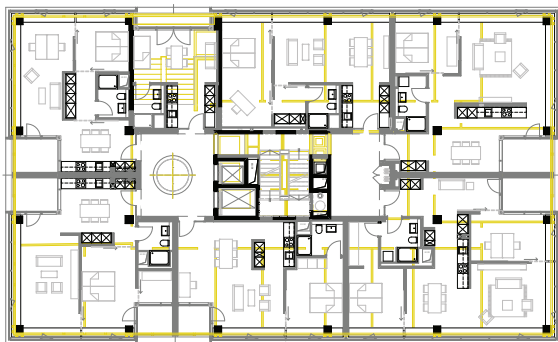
Grundriss 5. Obergeschoss neu
